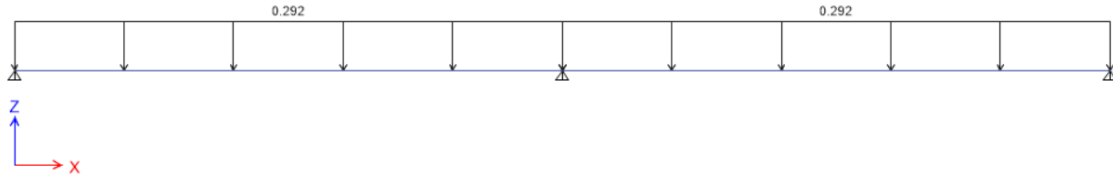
Carga ultima aplicada en la vigueta de la azotea.
